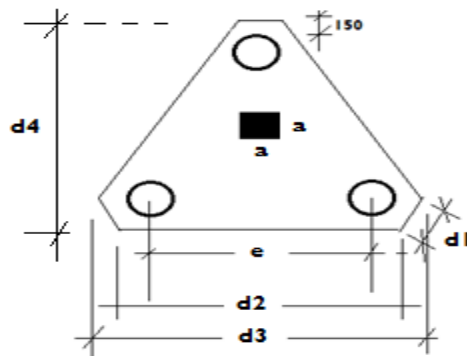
Vue en plan de la semelle sur 3 pieux
